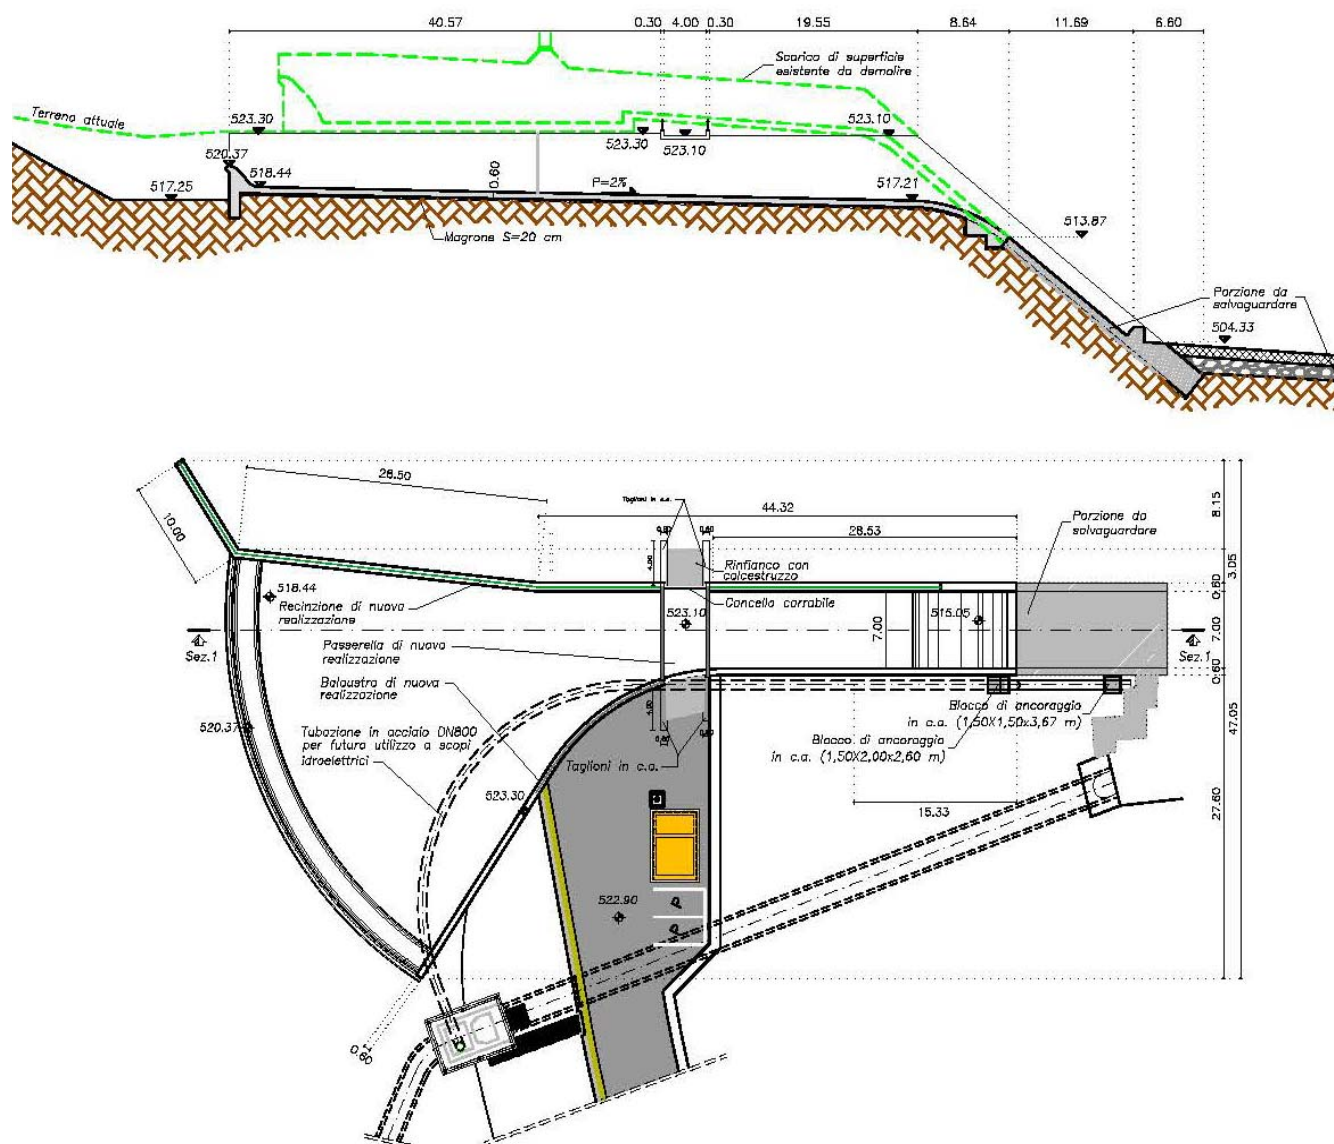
Sezione longitudinale e planimetria dello scarico di superficie in progetto
